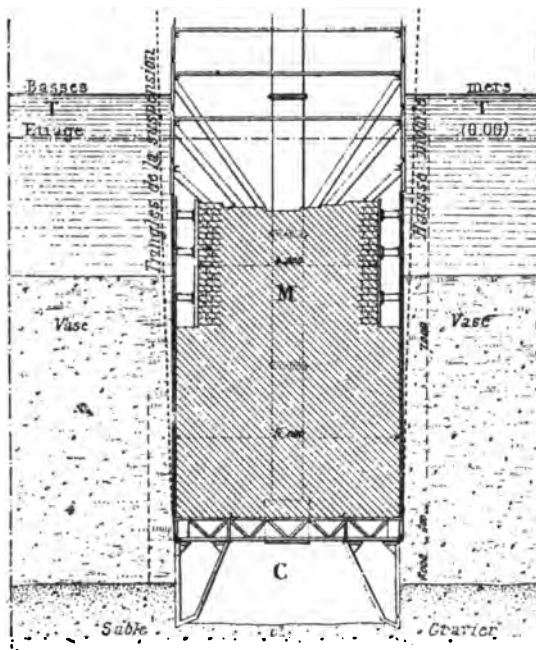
Bordeaux. — Caissons de fonçage (1^{er} type)
